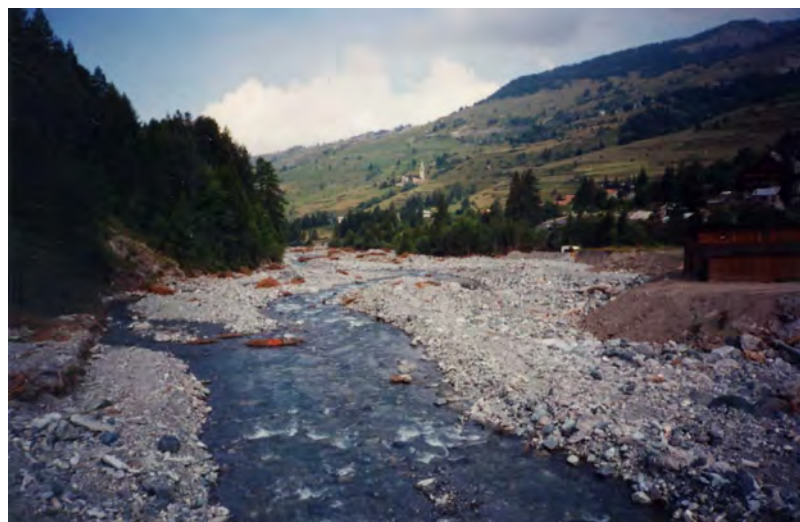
Ripa a Sauze di Cesana, località Ponte Albere: vista asta fluviale a valle dell'attraversamento, In sponda destra, ampiamente erosa dalla piena, lavori di ripristino.
